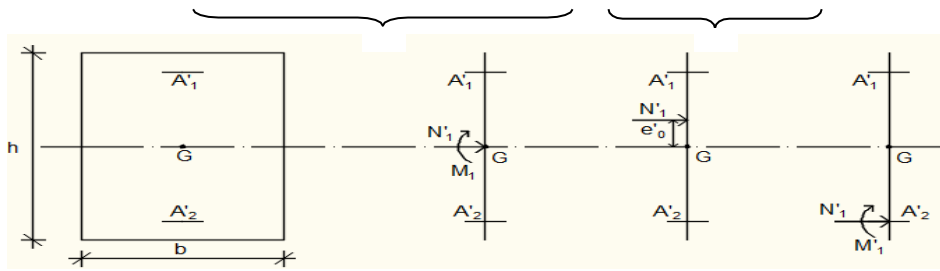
Position de N'1 M'1 et M1 sur la section transversale.
